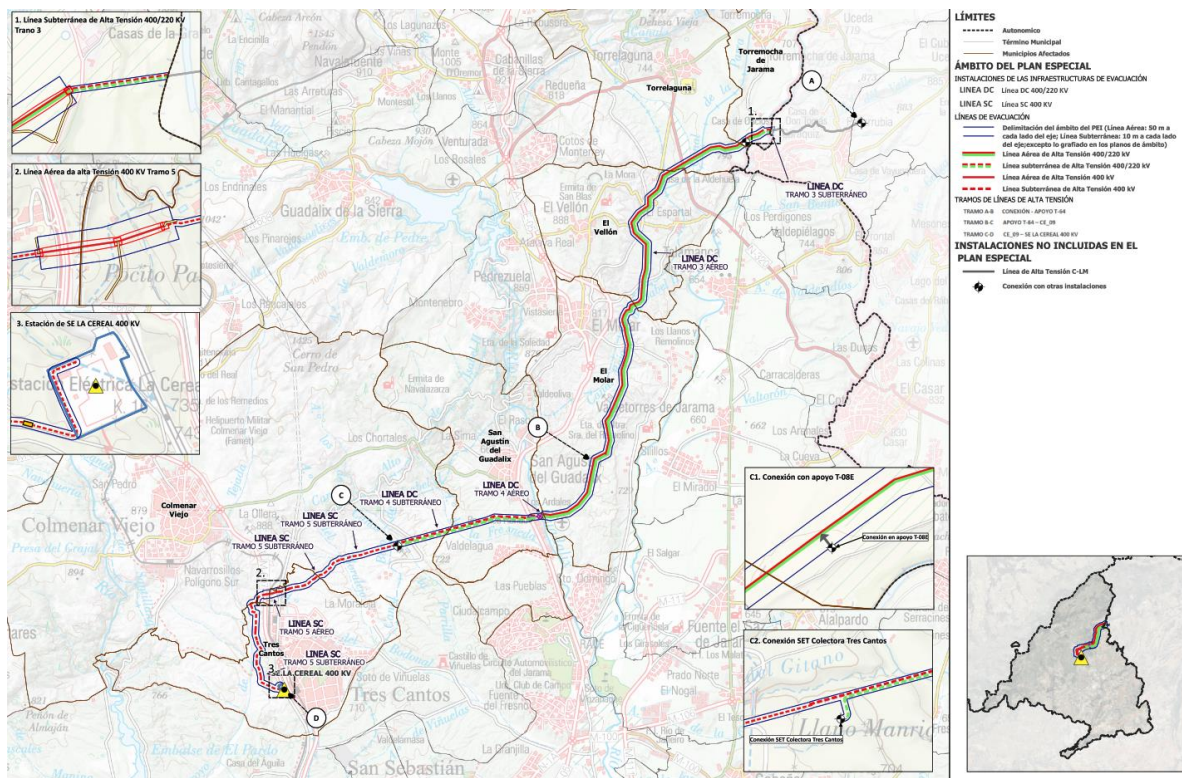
Plano de Ordenación O1. Planta General de Instalaciones
